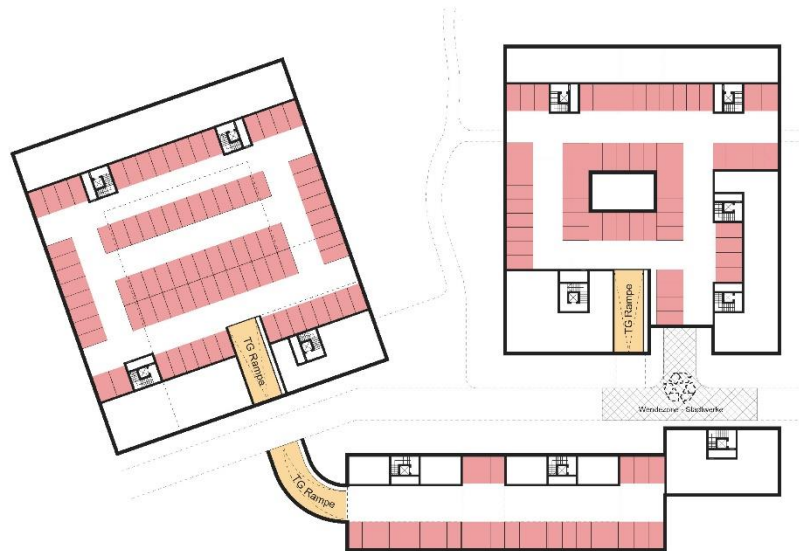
Rahmenplanung | Unterirdische Parkierung © LECKE ARCHITEKTEN
